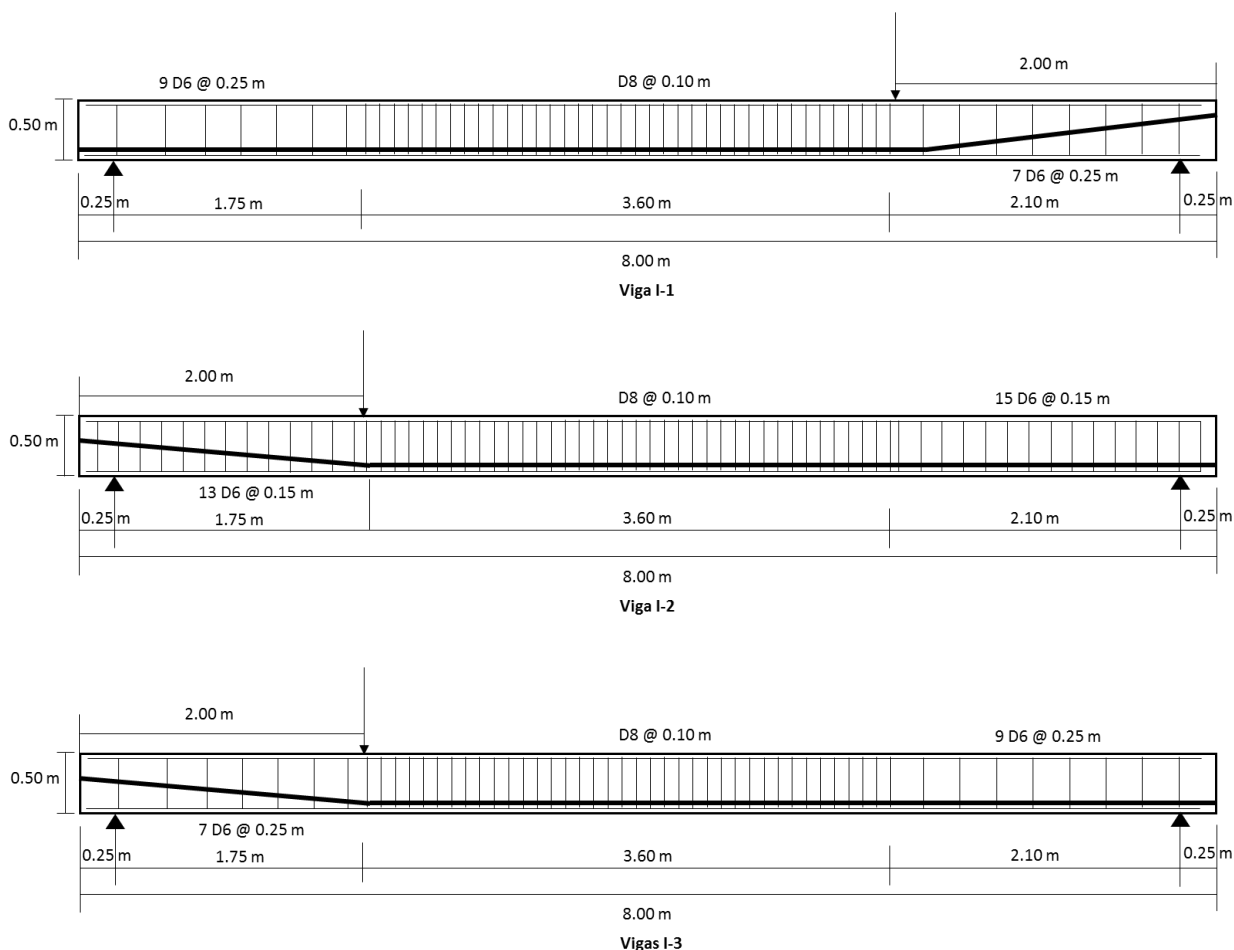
Distribución del acero activo y pasivo, dimensiones y detalles de las vigas de HPP.
